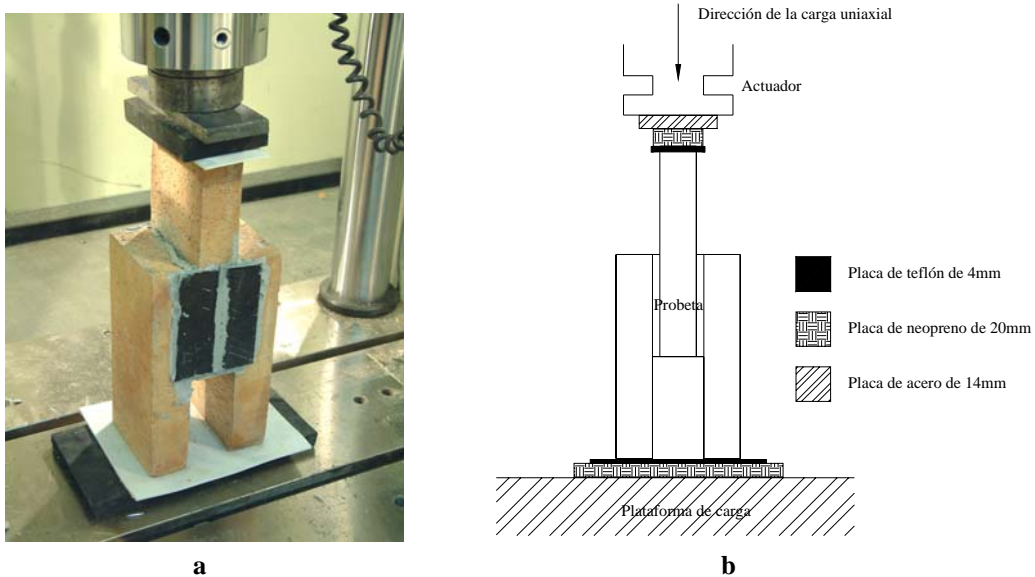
Montaje de los ensayos de tripletas bajo carga uniaxial: (a) montaje de una de las probetas antes de iniciar el proceso de carga; (b) esquema del montaje.
